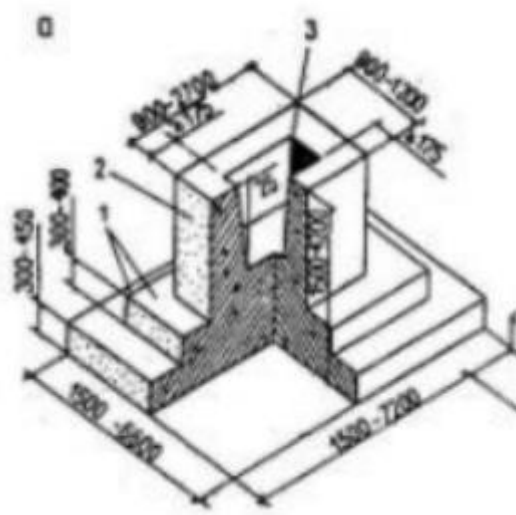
Монолітний стовповий залізобетонний фундамент, стаканного типу
